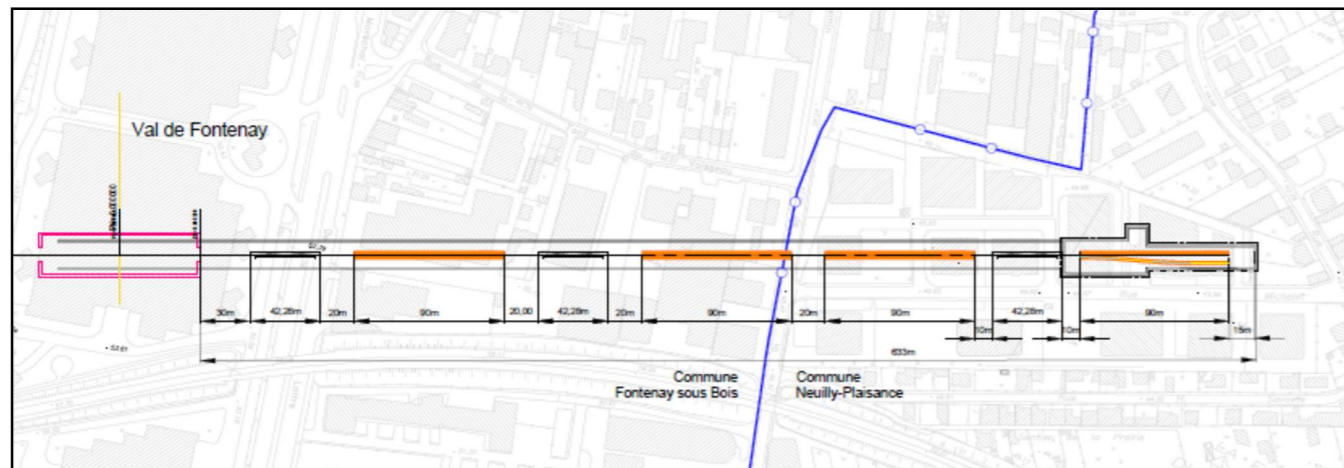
Plan des voies du CDT entre Val de Fontenay et le CDT (Source : RATP)
